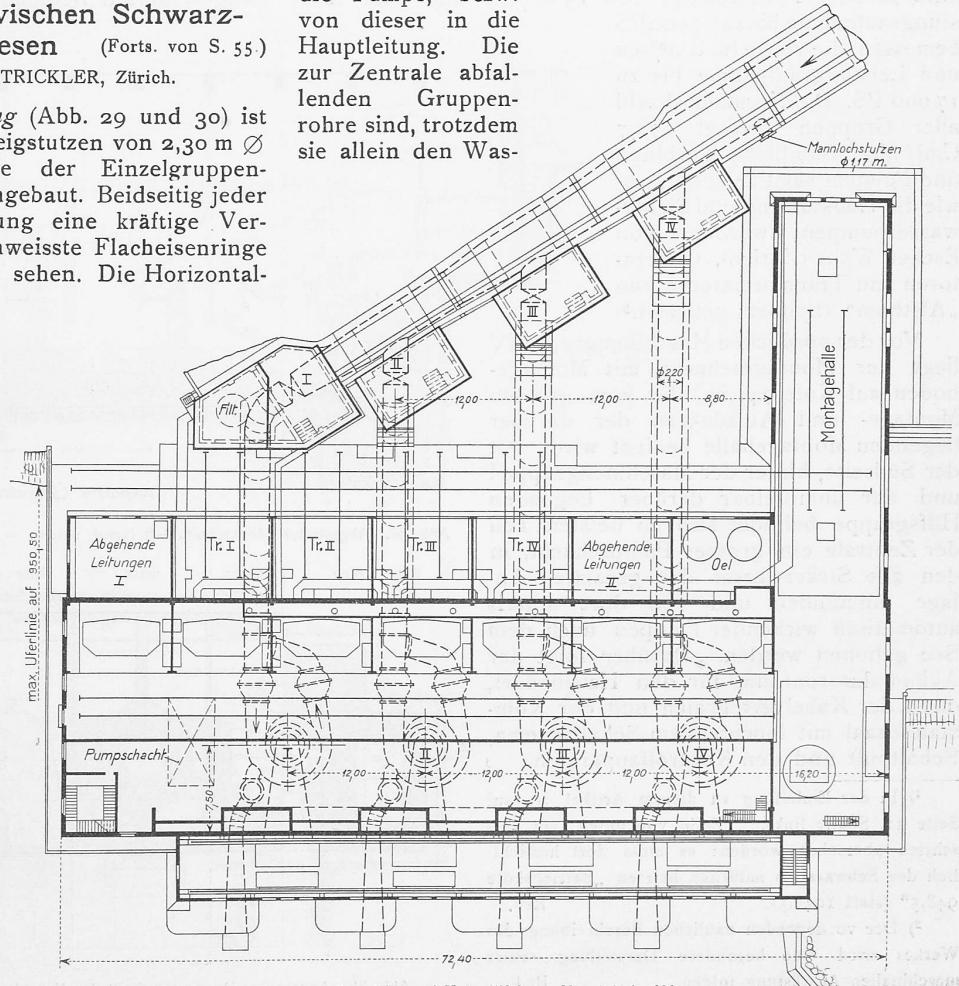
Verteilleitung und Zentrale, Grundriss auf Kote 952,0. — Maßstab 1 : 600.
